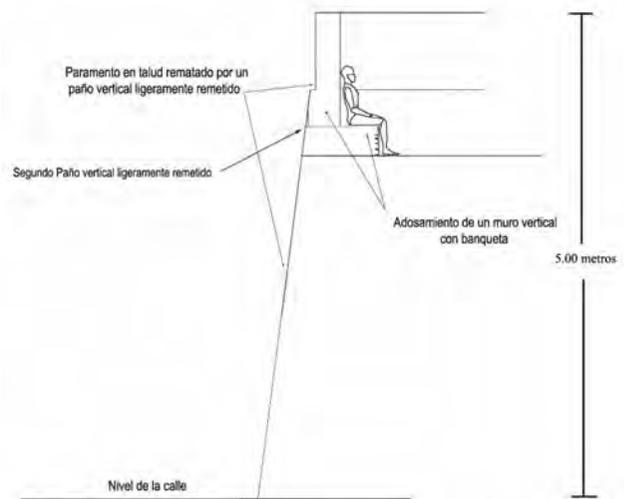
(plano 2) Croquis de corte longitudinal de la fachada sur de la plataforma. En el gráfico se puede observar cómo el adosamiento de la banqueta y paramento vertical cierra o tapia la vista hacia el poniente. En la fachada exterior se crea un juego de tableros al formar un segundo (de abajo hacia arriba) paño ligeramente remetido.
